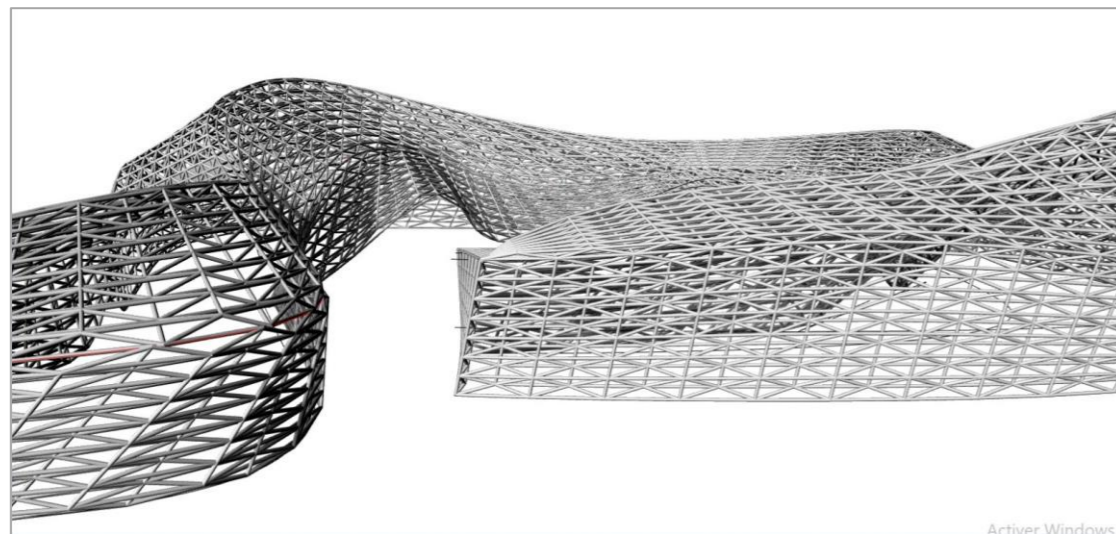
Schéma de la structure tridimensionnel de notre projet. Source :
